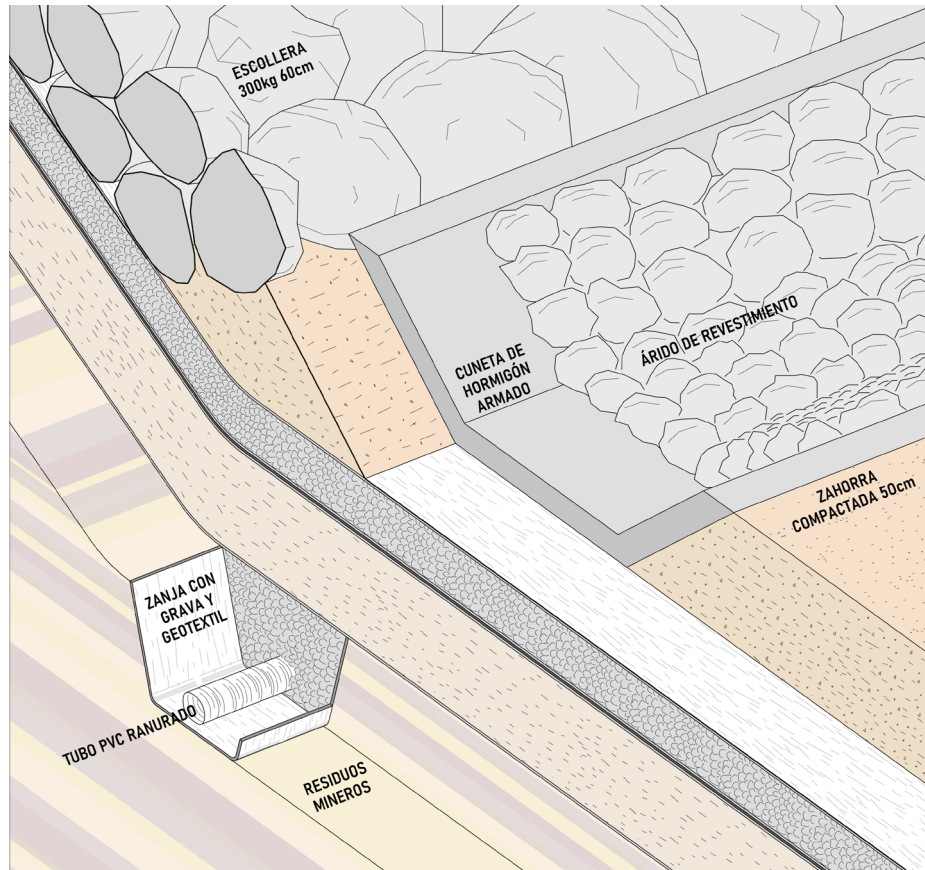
Detalle de construcción de cuneta impermeabilizada en tratamiento T1.
